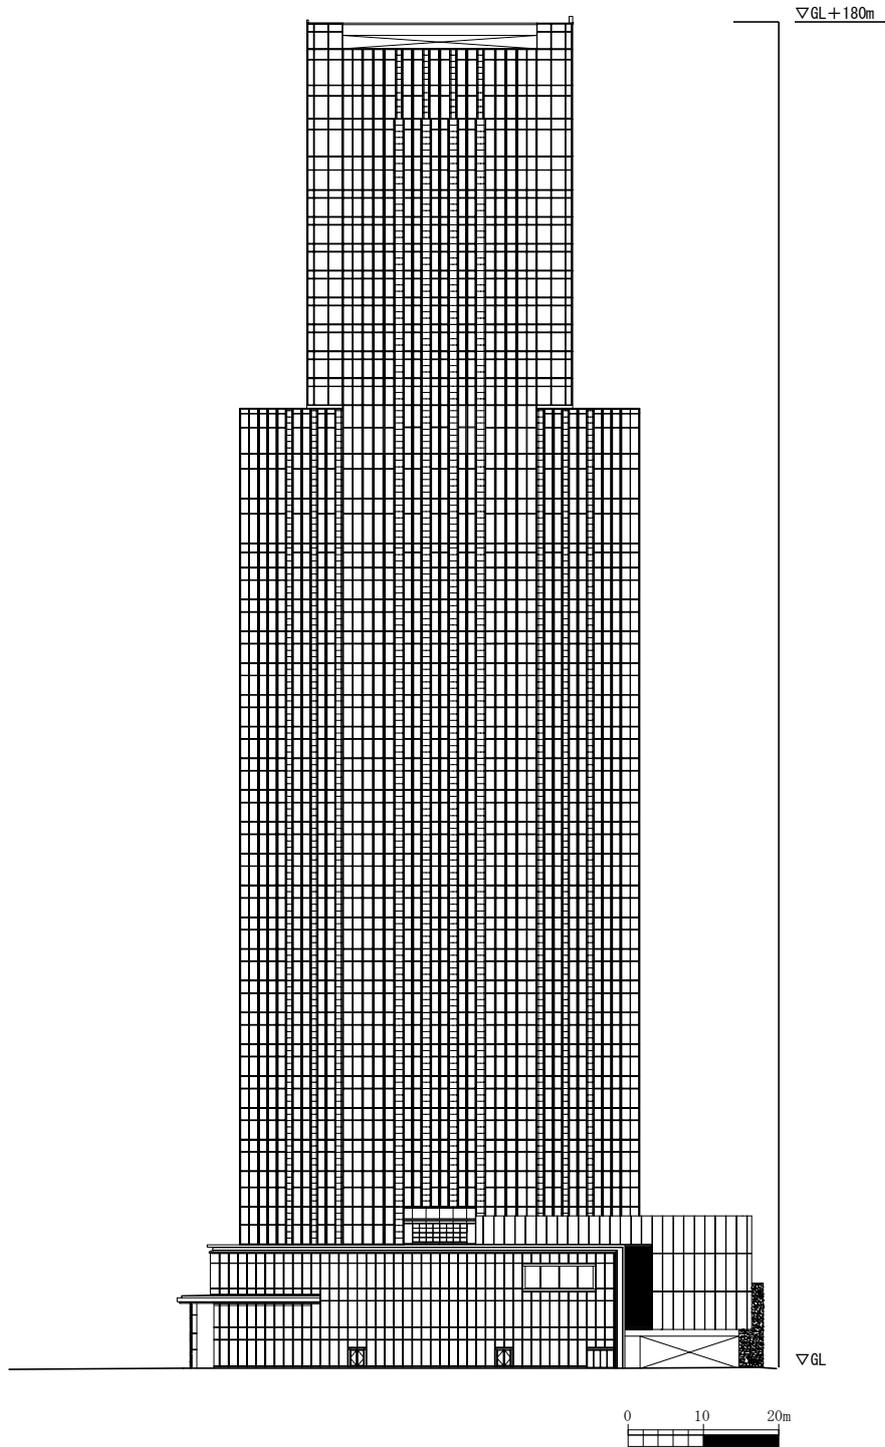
(7) 計画建築物立面図 (北側) (完成(竣工))
